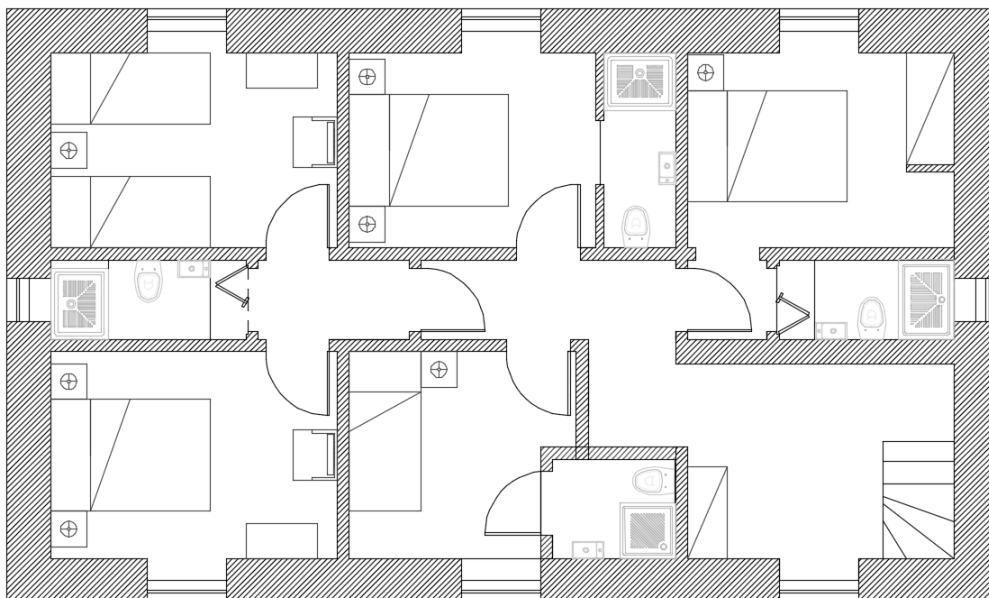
Planta de proposta do primeiro andar. Escala 1/100. FONTE: Cristina Popadia.
